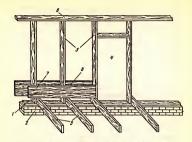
Конструкция каркасно-обшивной перегородки: 1 и 6— нижняя и верхияя обвязки; 2— кирпичный цоколь; 3— балка цокольного перекрытия; 4— проем для двери; 5— стойка каркаса перегородки; 7— обшивка; 8— минераловатные плиты
